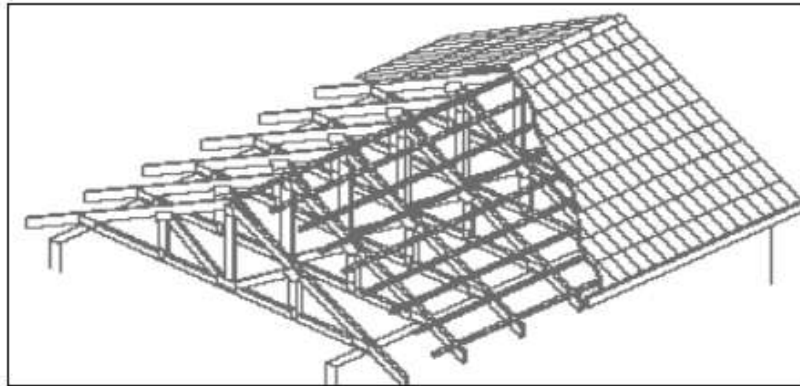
Estrutura de cobertura no sistema pré-fabricado
